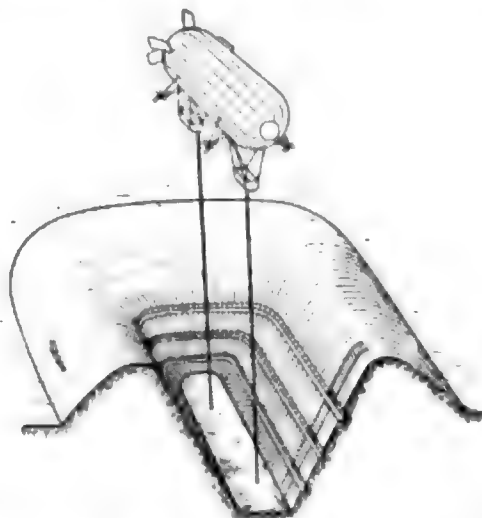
Nothafen (Ersatz für Ballonhallen) für Luftschiffe, bestehend aus einer Grube mit umgebendem Wall.
